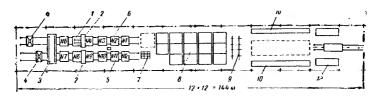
Габаритиая схема технологической планировки УТП-1 производства керамзитобетонных наружных стеновых паиелей для домов серии 1-464A с вариантом для трехслойных панелей (04-09-7)
